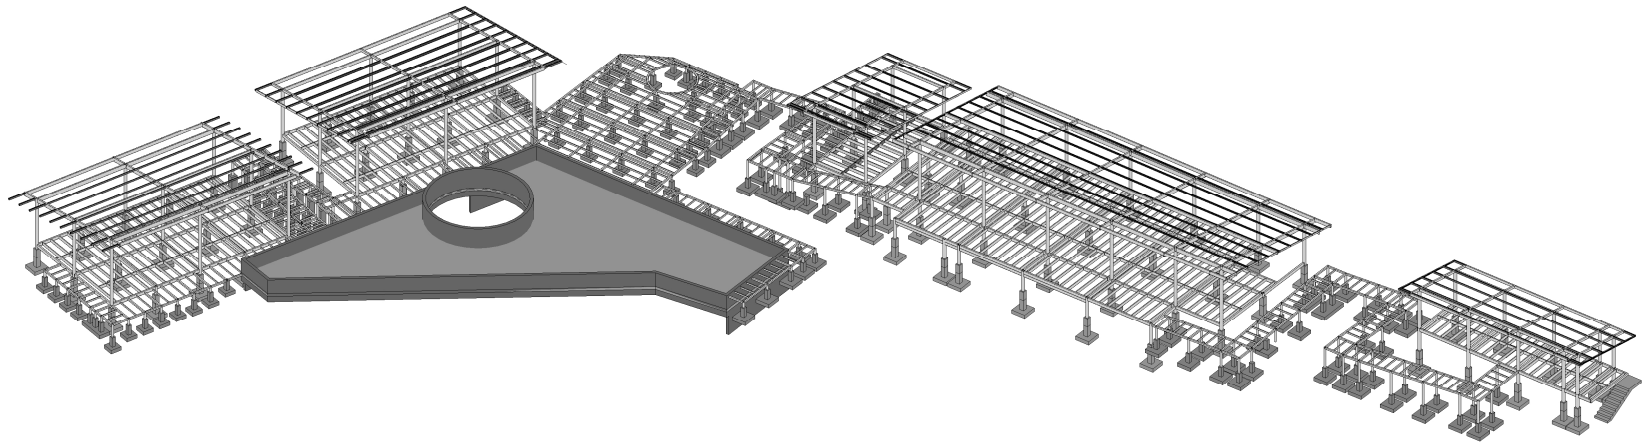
Esquema estructural de la propuesta en acero, conjunto. Fuente: Elaborada por el autor.
